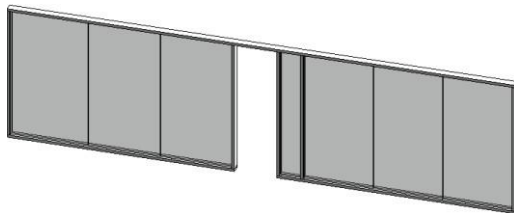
Vista de alzado de rejillas exteriores de ventilación de la sala de instalaciones.
